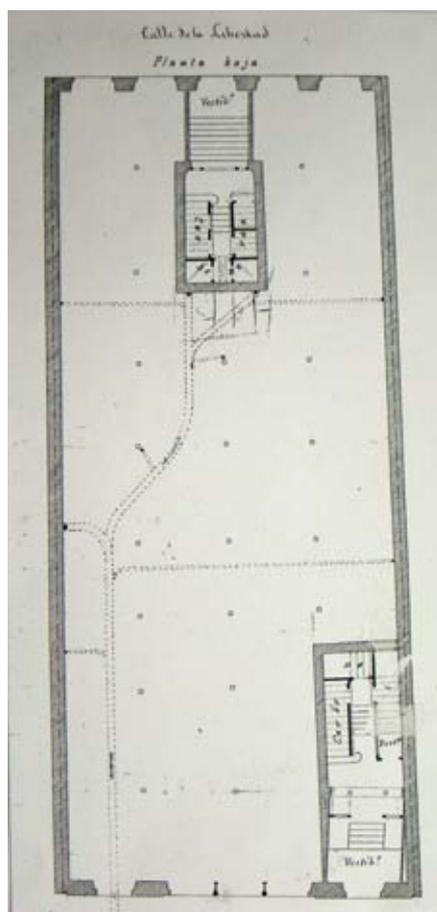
Planta baja incluyendo red de saneamiento. Edificio de Elena Valdés.
